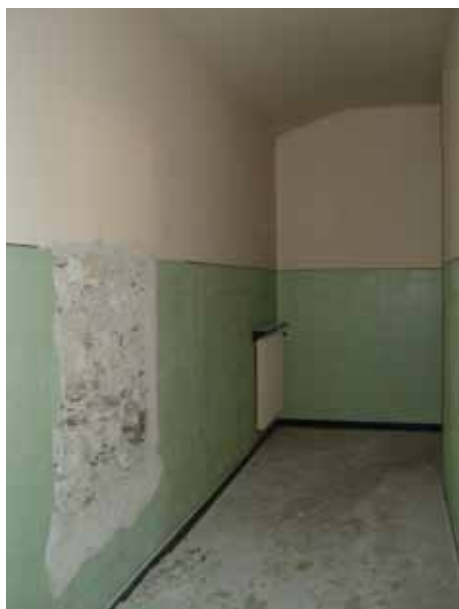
Piano primo cemento armato – muratura di confine tra le porzione in cemento armato e quella in muratura
